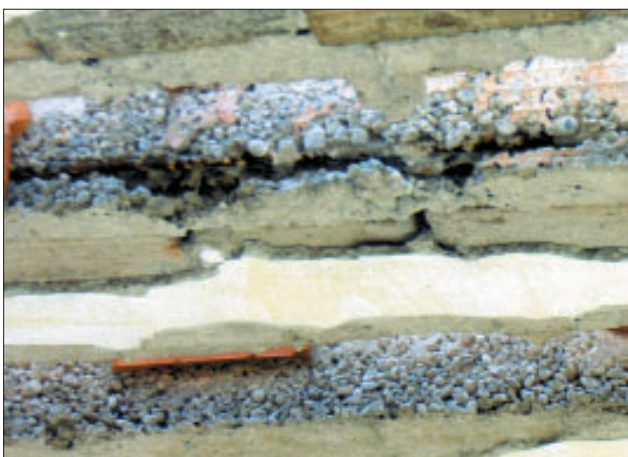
Beispiel für mangelhaft verdichteten Beton in Stahlbetonrippendecken
